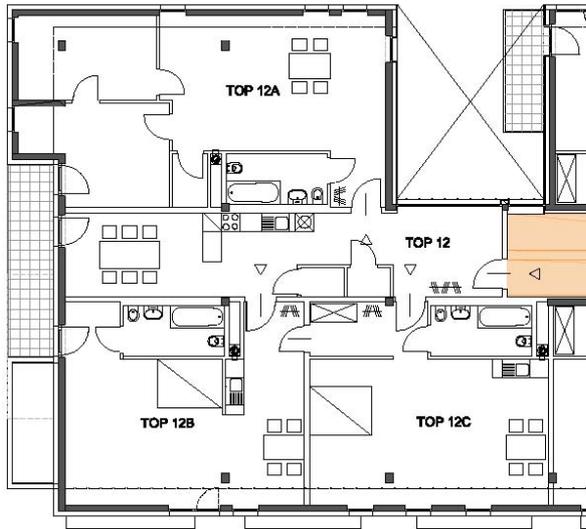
Frauenwohnprojekt [ro\*sa] Donaustadt, Grundriss Wohngemeinschaft; maßstabslos.
